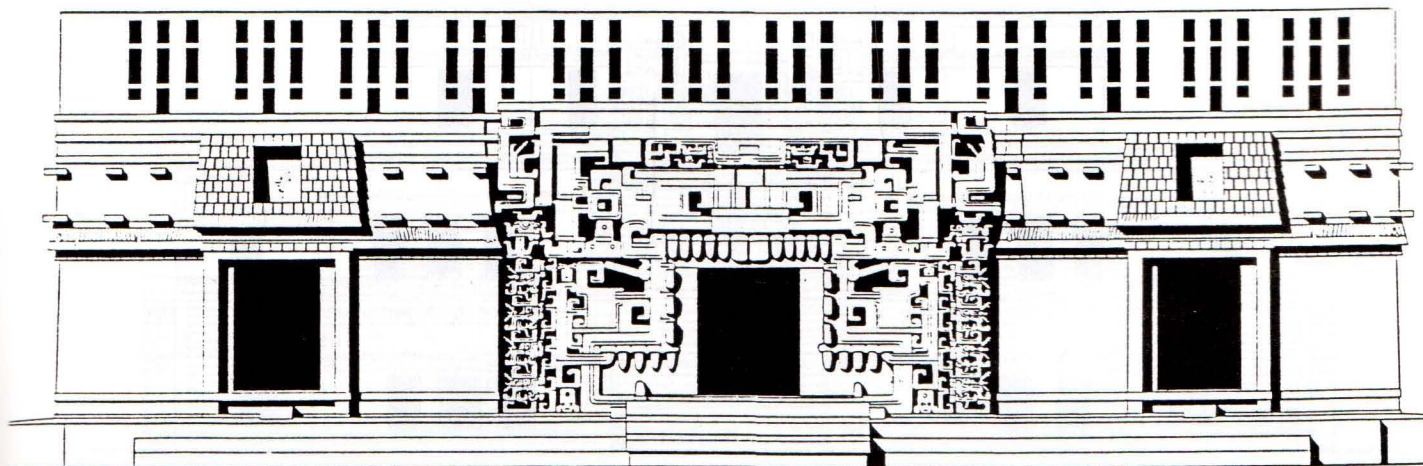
Estructura II de Chicanná, alzado oeste. Muestra mascarón zoomorfo central y crestería.
